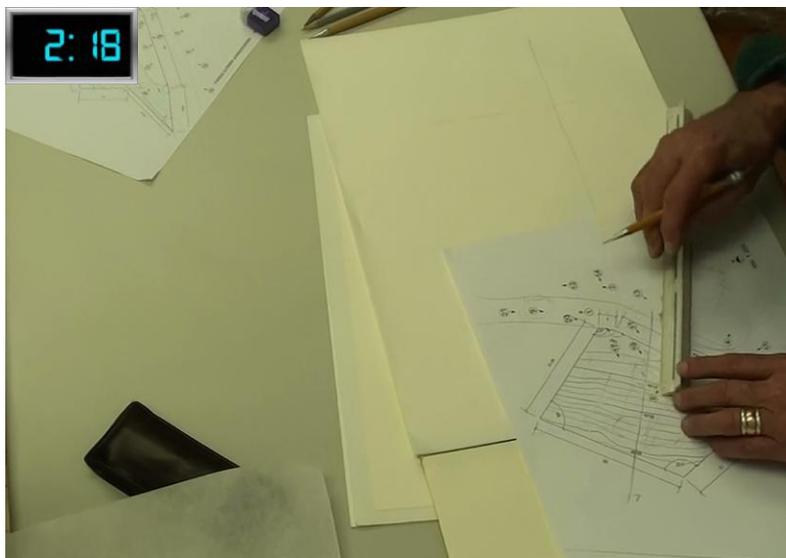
Arquiteto conferindo medidas para o corte na escala 1:100
